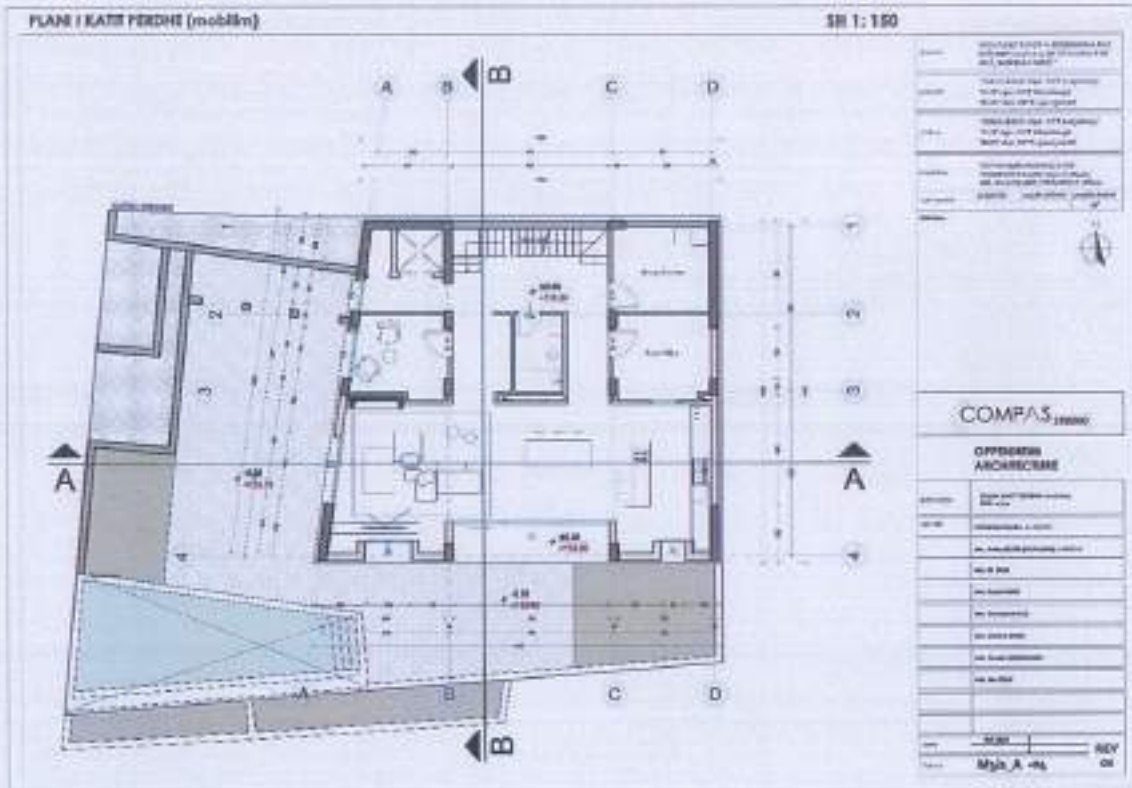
Vila M3/a \_Planimetria e kati përdhe
